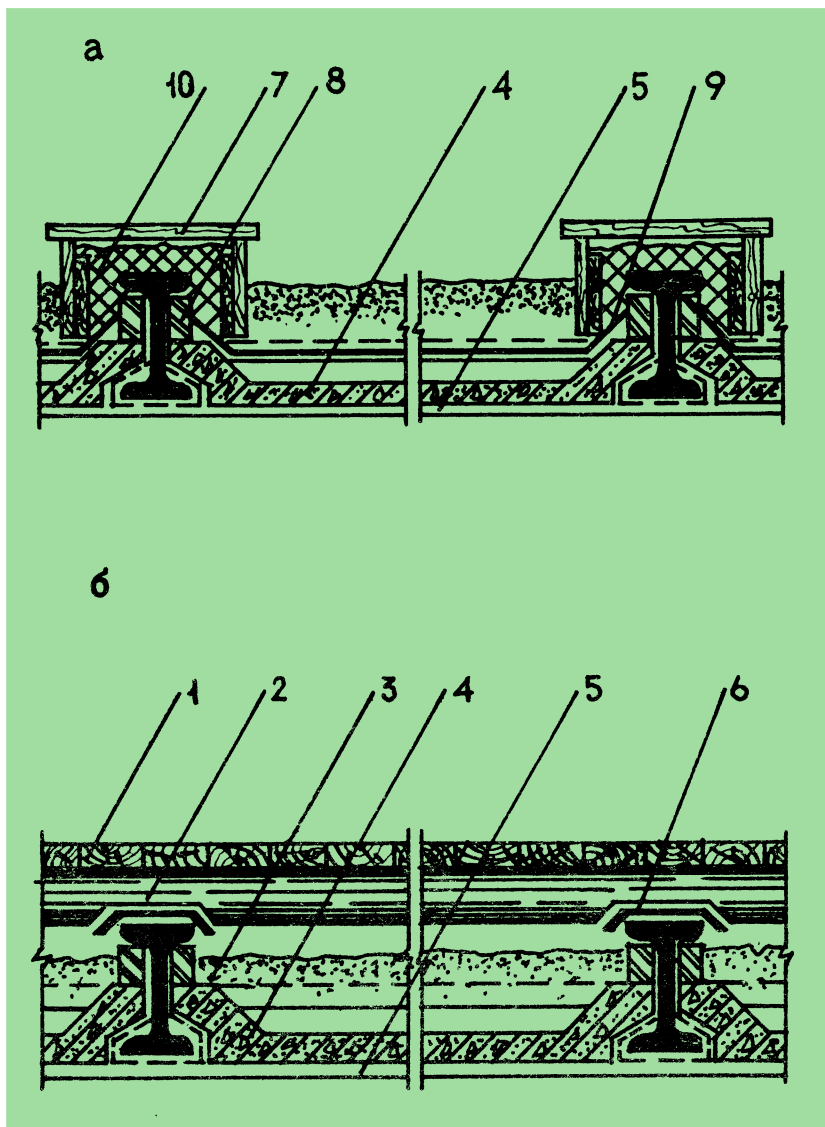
Перекрытия по металлическим балкам из сборных железобетонных плит:
